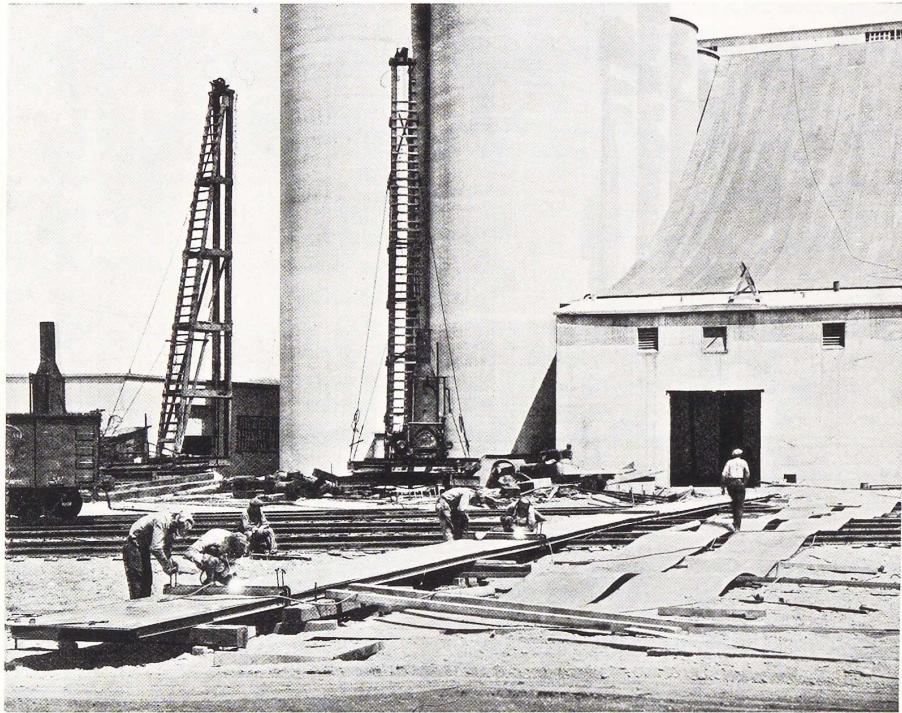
Les tôles constituant chaque bande sont assemblées par soudure bout à bout sur un calibre constitué par un cadre en fers profilés.
